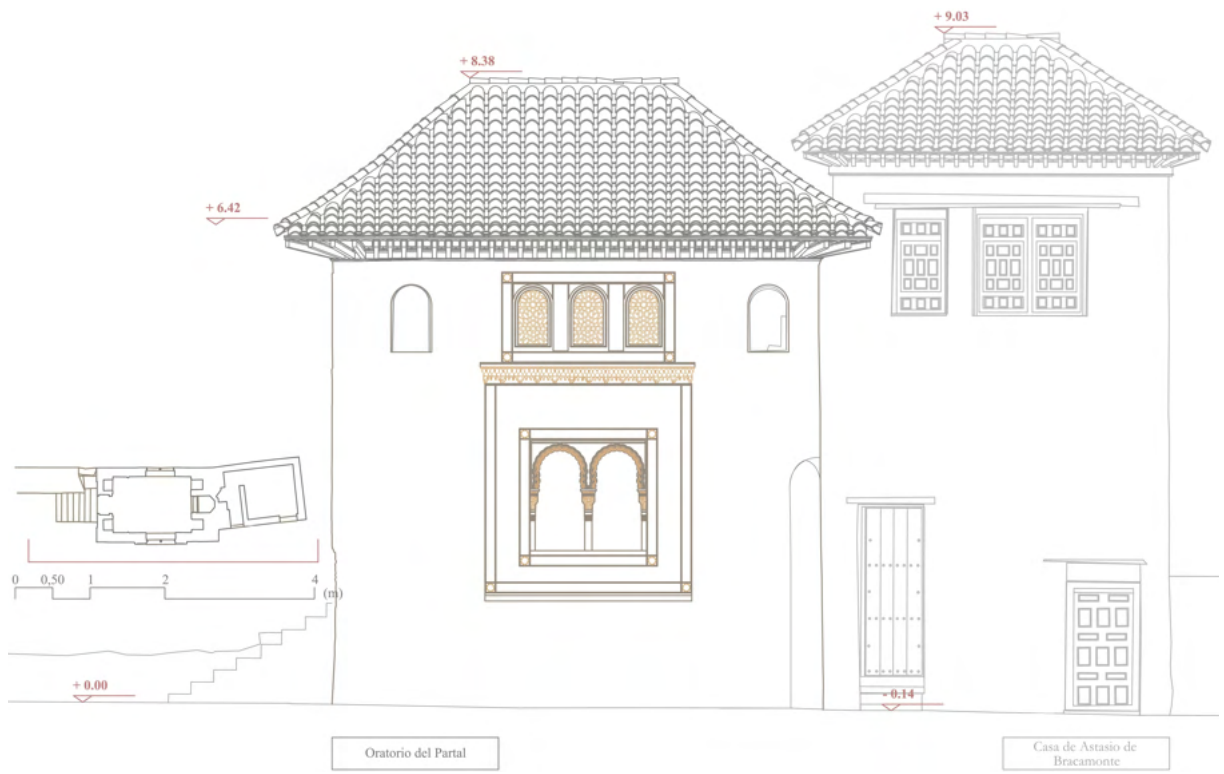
Plano del oratorio. Alzado exterior noroeste.
